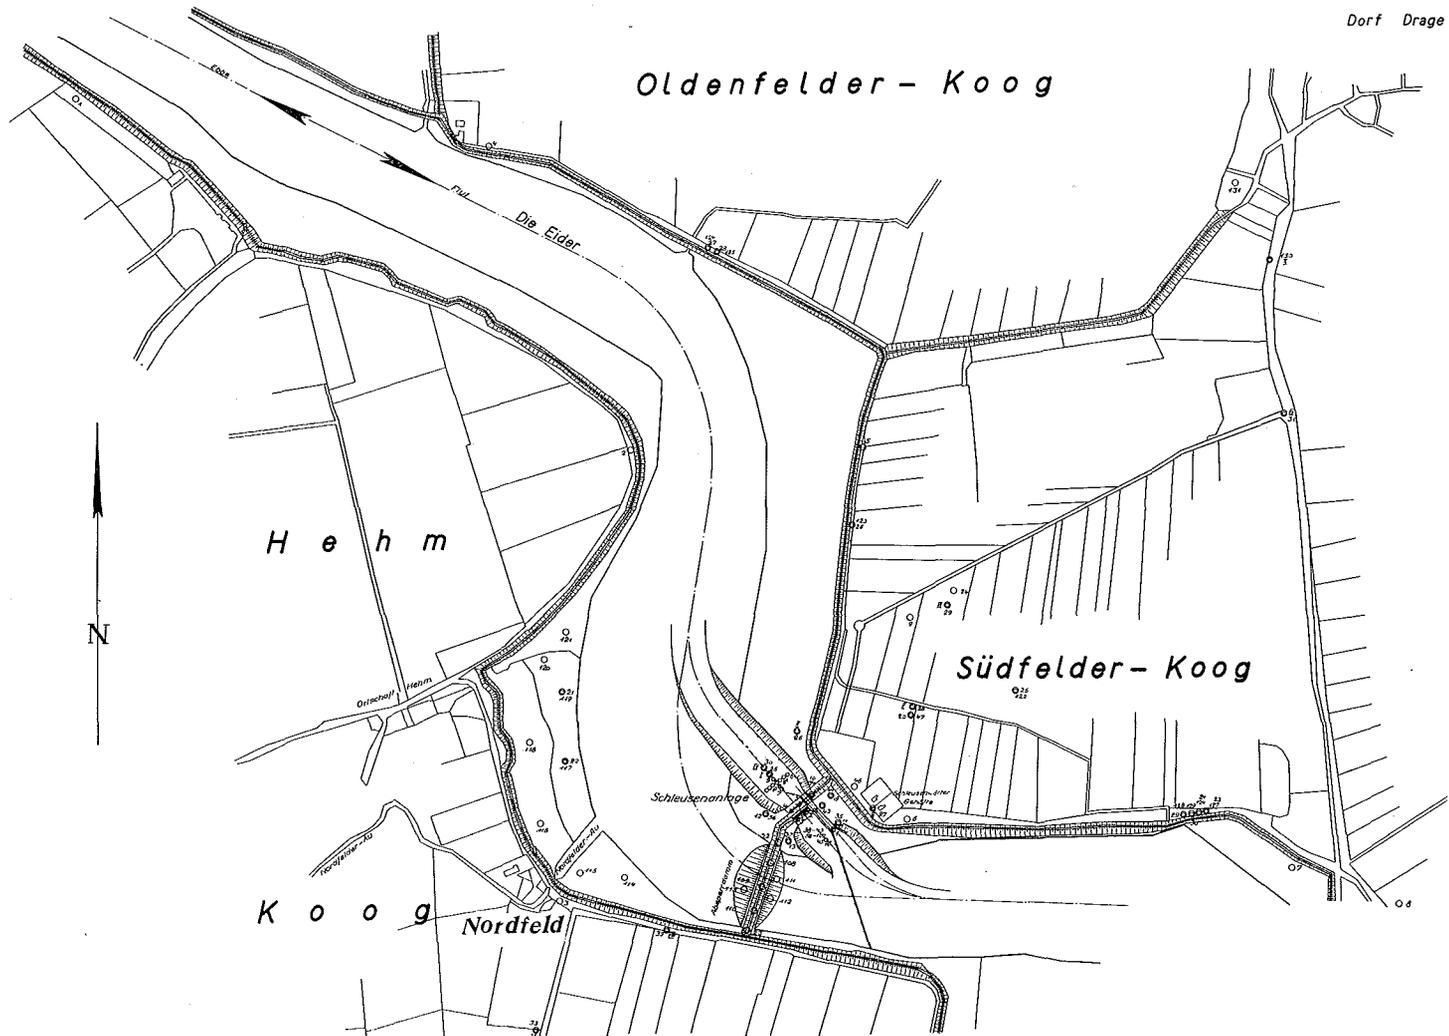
Lageplan der Schleusenbaustelle und der Abdämmung bei Nordfeld.
